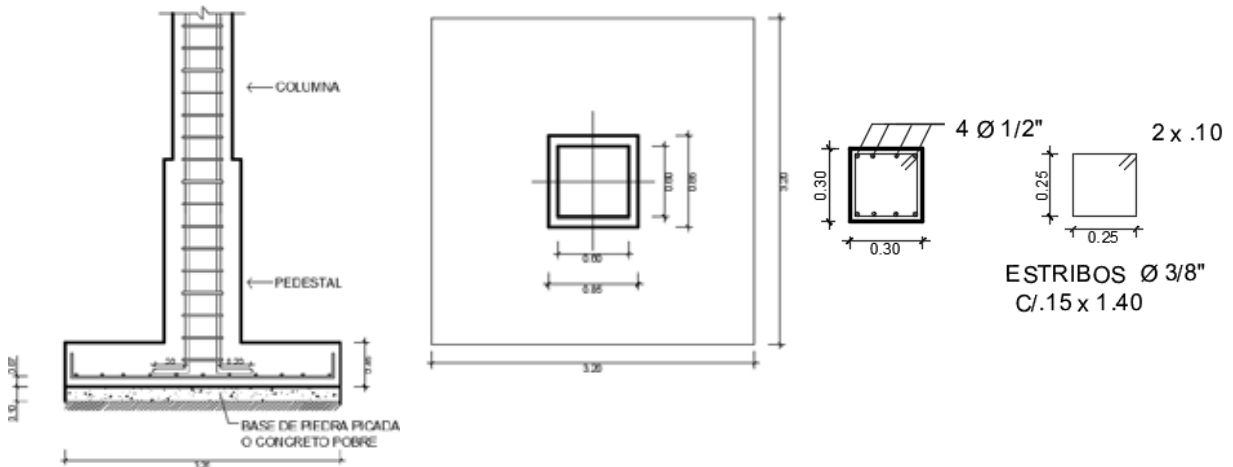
Detalle de zapata, pedestal, columna y viga de riostra. *La Autora*, (2017)
